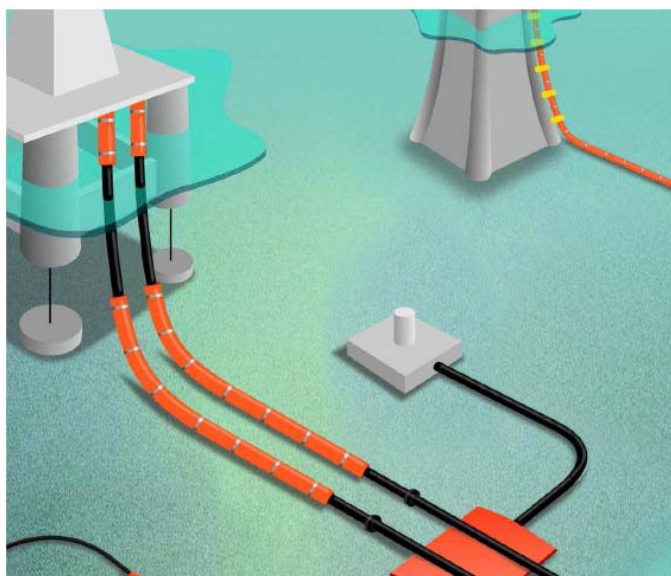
Защита механическая гибкого трубопровода. План общий
